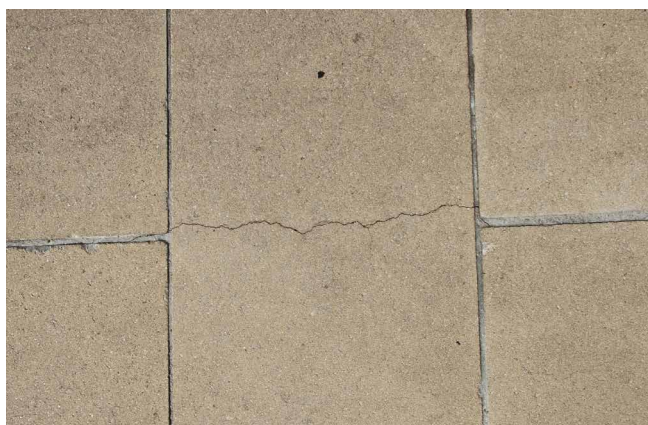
Gerissene Betonplatten in einer gebundenen Pflasterdecke
